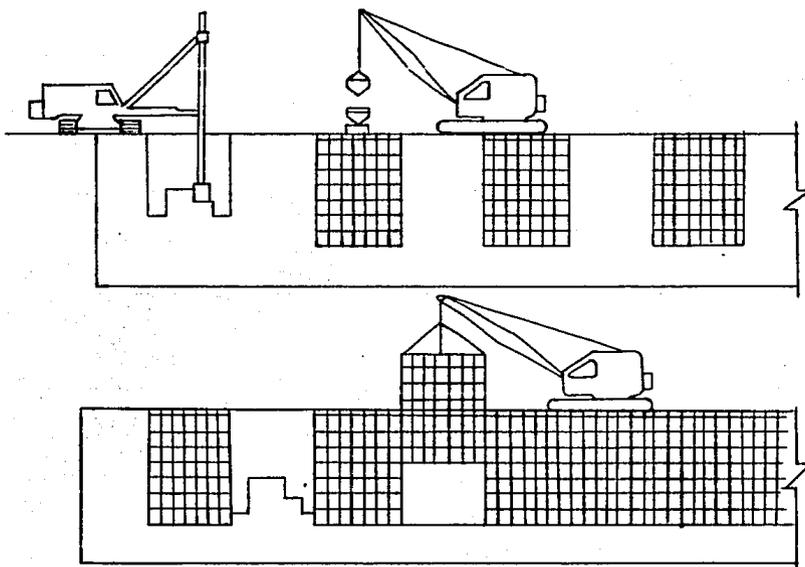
CONSTRUCCION DE MURO MILAN.
